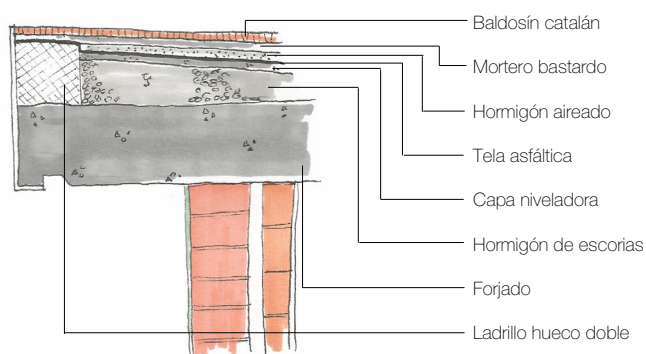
Detalle en sección de cubierta plana (autoría propia).
